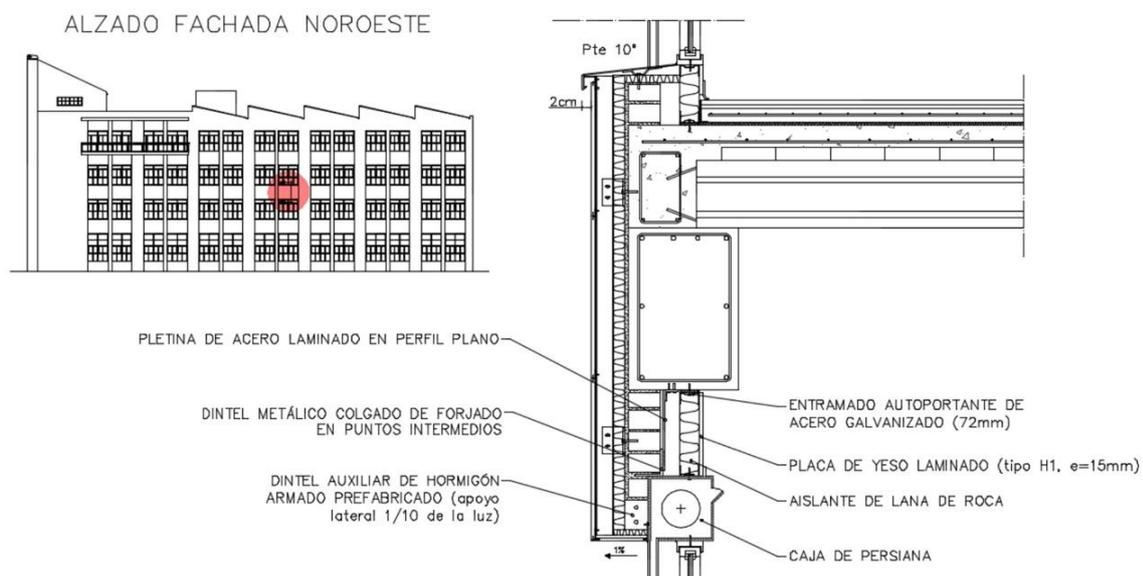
Sección de fachada ventilada por dintel de hueco de ventana. Fuente: elaboración propia
